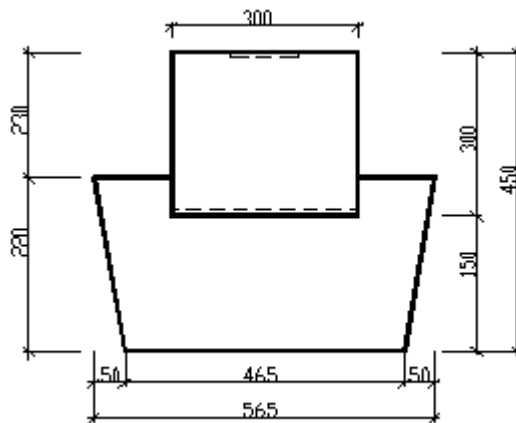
Поперечний переріз конструкції залізобетонного ригелю
